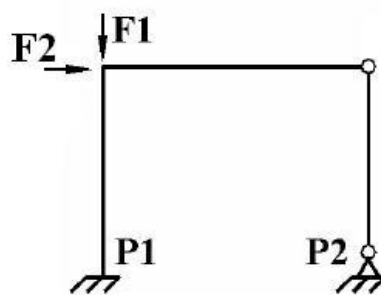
Elemento de contraventamento e elemento contraventado.
